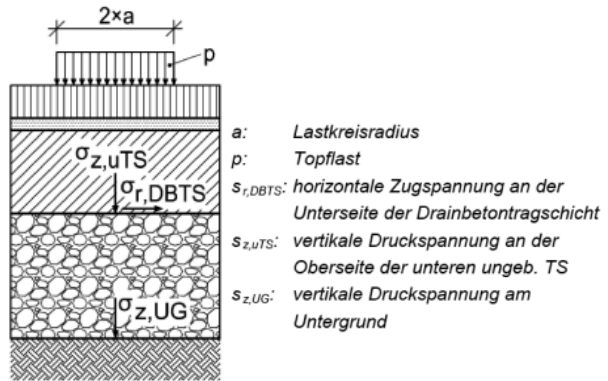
Maßgebende Spannungen bei Bauweise mit Drainbeton-Tragschichte [1]
